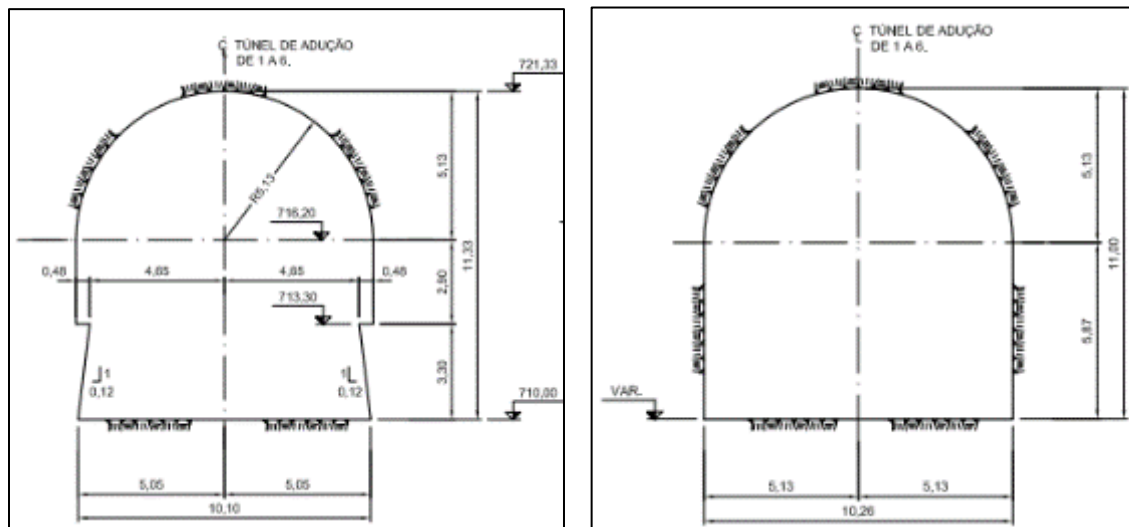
Secções adoptadas na escavação dos túneis de adução. Esquerda: escavação em abóbada e rebaixo. Direita: escavação em secção plena (adaptado de Intertechne, 2014)
